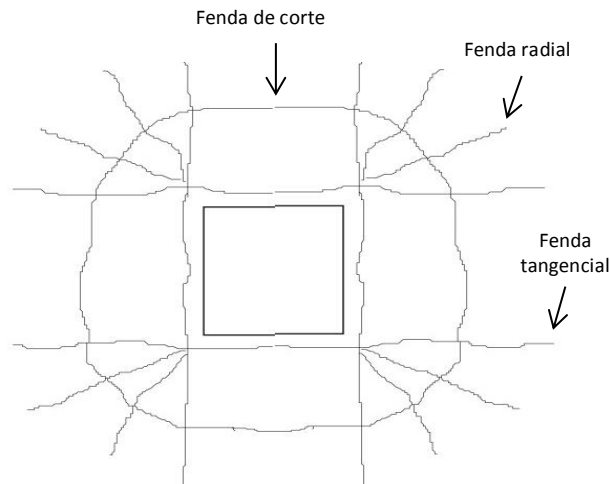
Representação das fendas na face superior da ligação pilar-laje (adaptado de Ramos e Lúcio, 2006)
